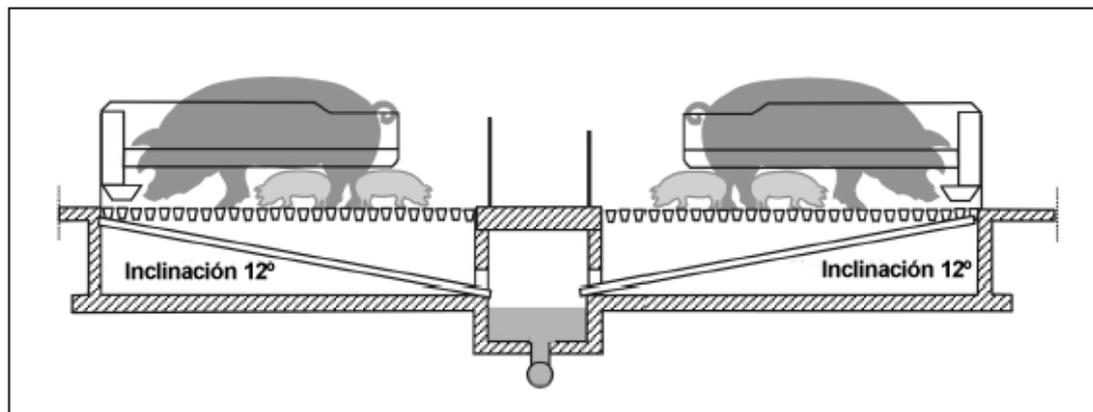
Plancha en pendiente bajo el suelo enrejado
